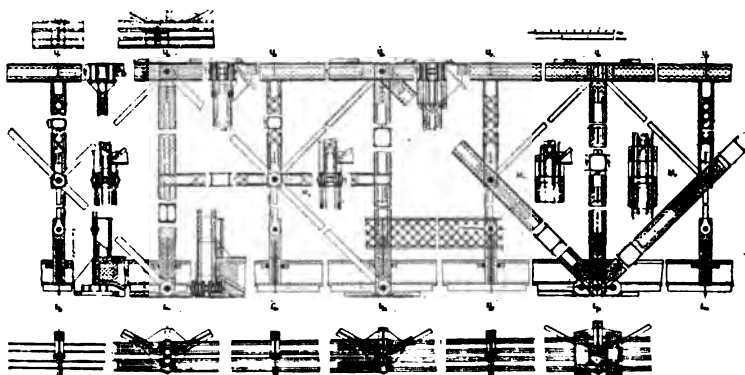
Pont de Bellefontaine. Travée de 134m,20 (suite).
